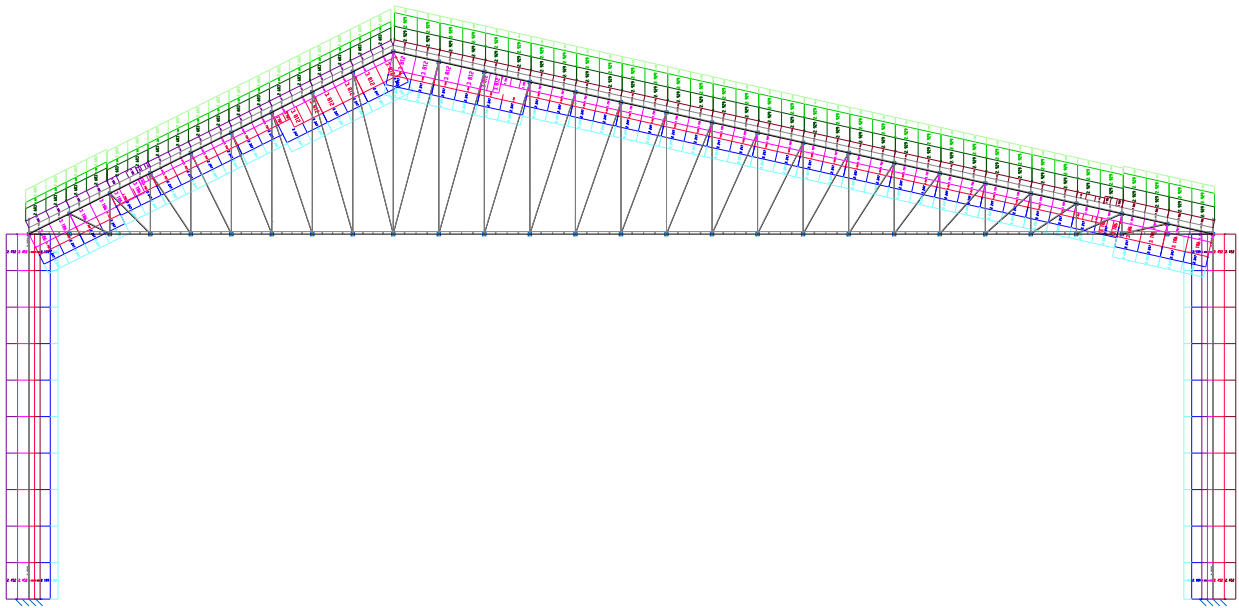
Cargas aplicadas sobre el pórtico 5
